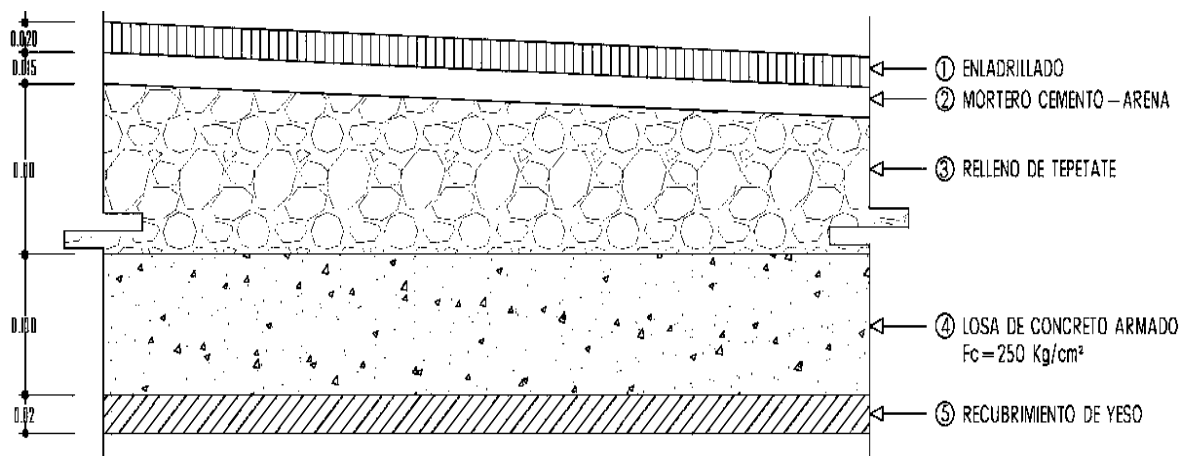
detalles de los espesores de la losa horizontal con pendiente menor a 5%.
